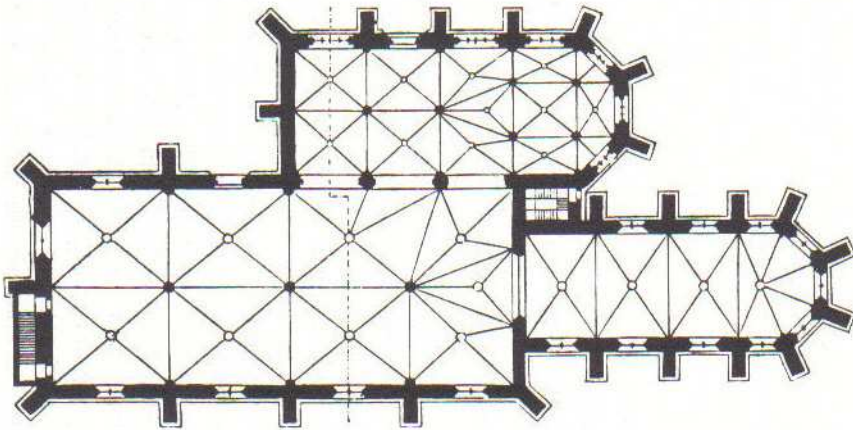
Grundriss der ehemaligen Minoritenkirche mit Wallseerkapelle
